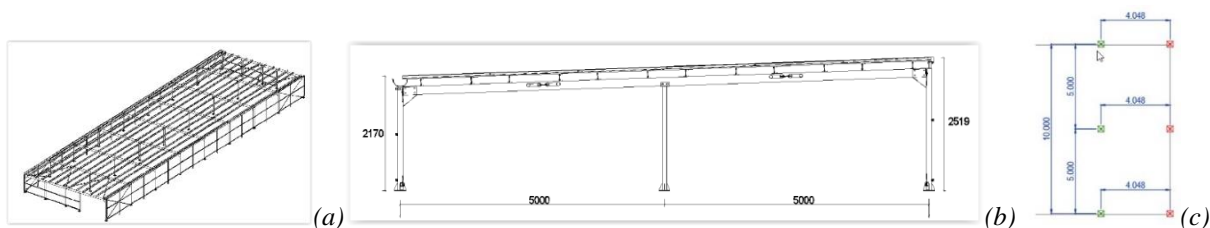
Esquema de uma estufa tipo: a) Perspetiva b) Corte c) Planta (parcial).
